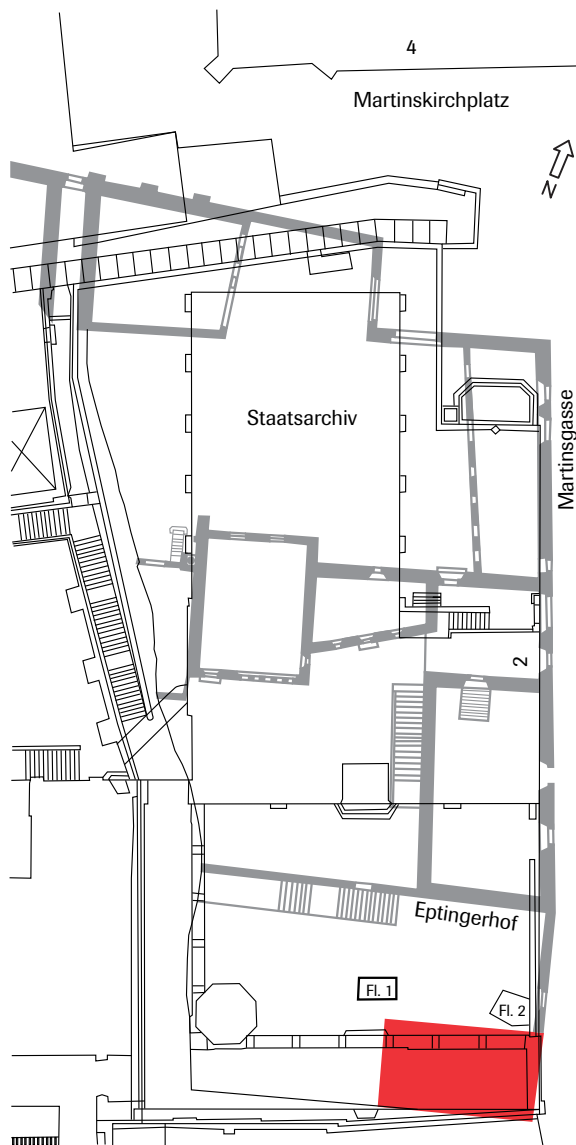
Plan des Eptingerhofs (grau) mit dem Grundriss des Wohnhauses des Staatsarchivars Rudolf Wackernagel (rot). – Plan: Christian Stegmüller. – Massstab: 1:500.
